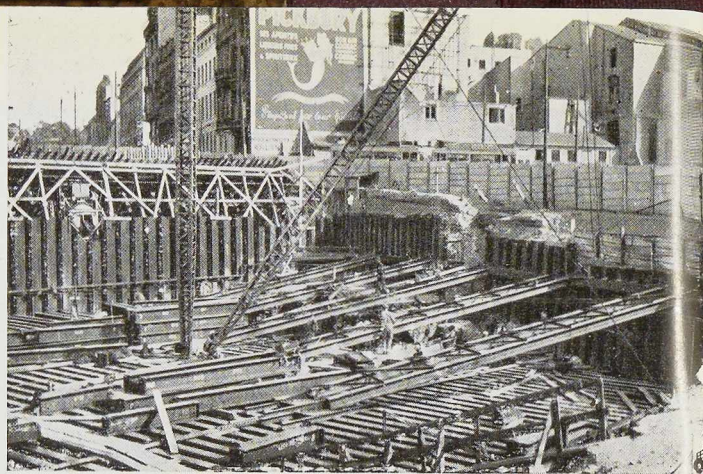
Vue des travaux de la jonction Nord-Midi dans sa traversée du boulevard Botanique. Noter le radier en poutrelles à larges ailes, ainsi que les rideaux de palplanches avec leurs poussards.
